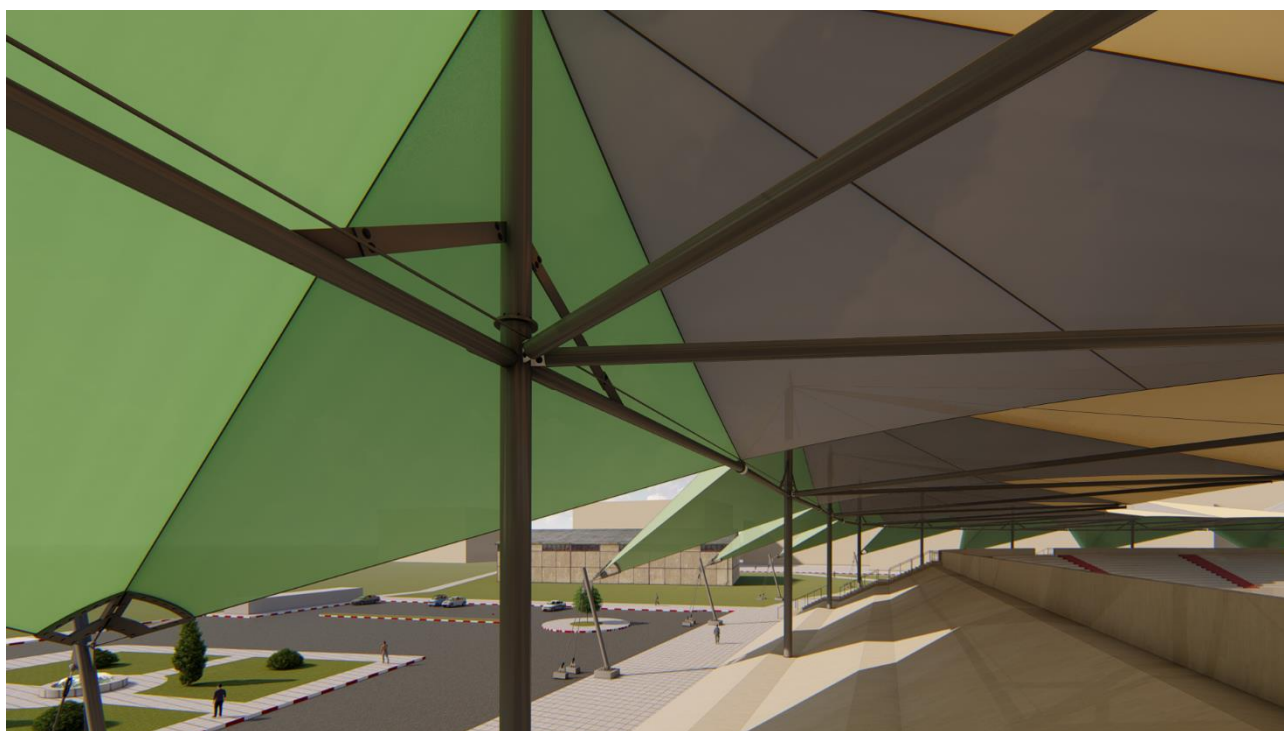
Vue sur élément structurel. Traitement d'un nœud structurel
